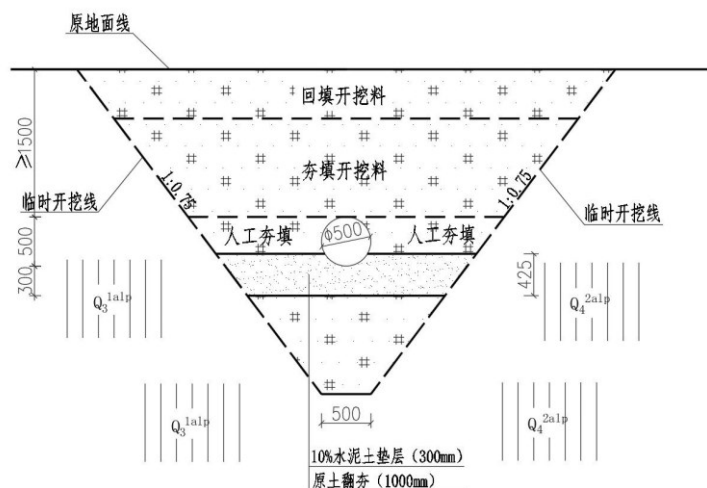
管道基础横断面图（马兰黄土、粉质壤土地基）
